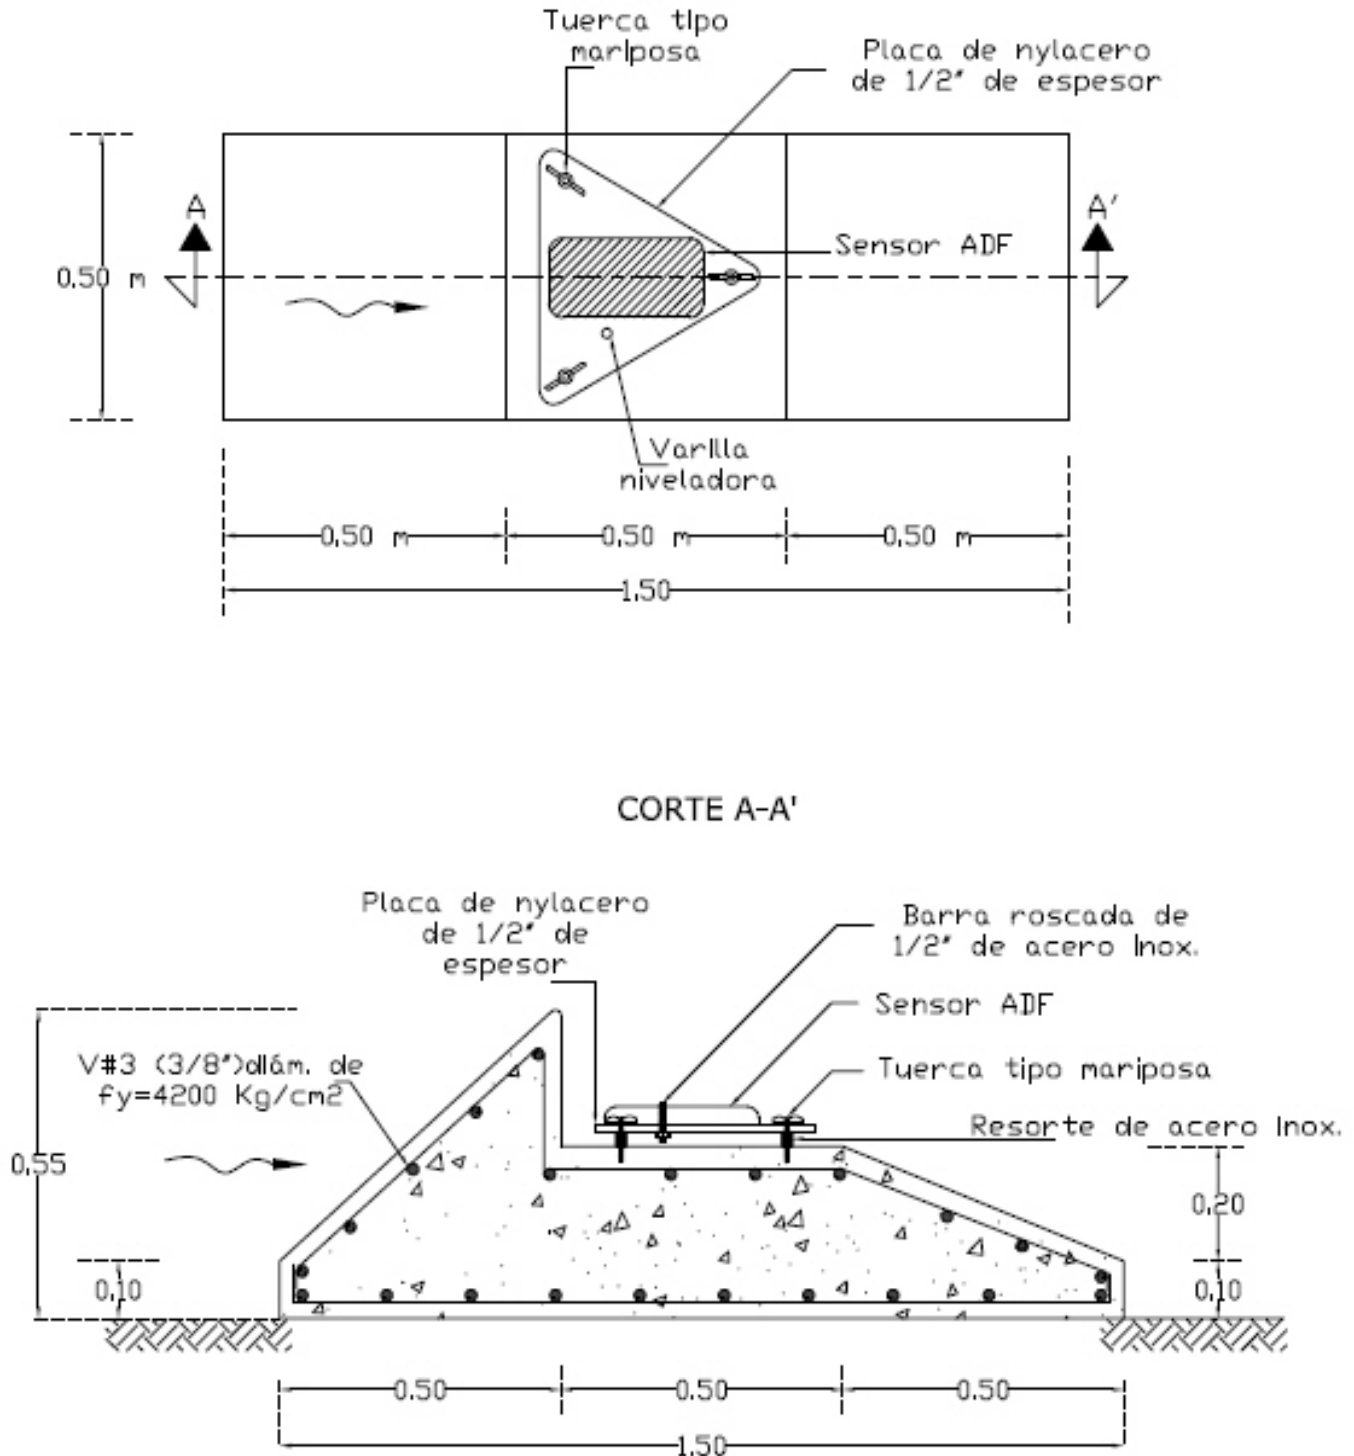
Croquis constructivos del contrapeso de concreto para el sensor en la estación "Cañón de Fernández"
